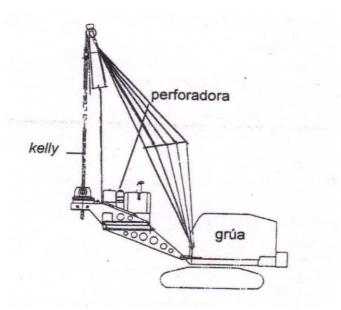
Perforadora rotatoria montada sobre grúa.
